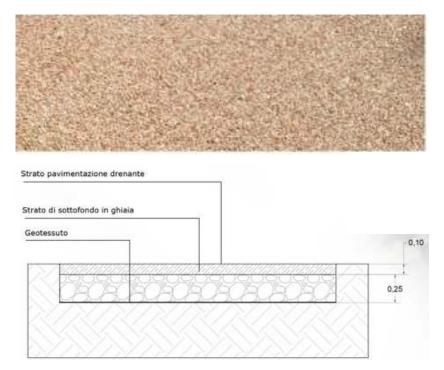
Esempio di pavimentazione in calcestruzzo drenante - Estratto Tav.04.a_Planimetria generale_sdp.
